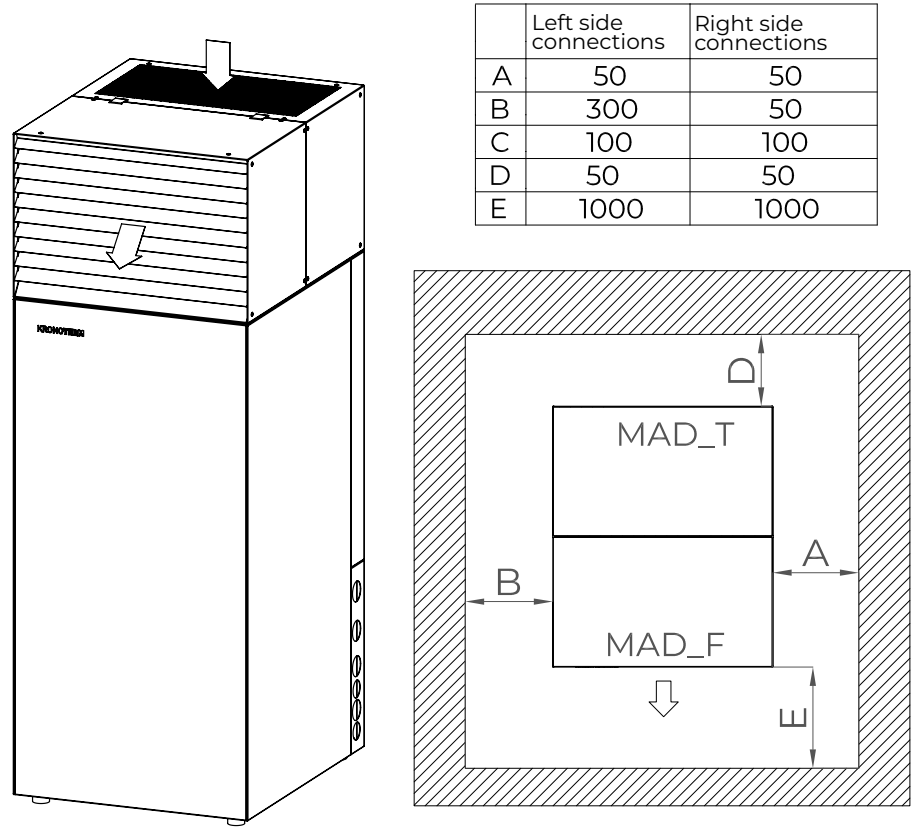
Bijlage 15_a - Plan voor het installeren van VERSI-X + MAD
